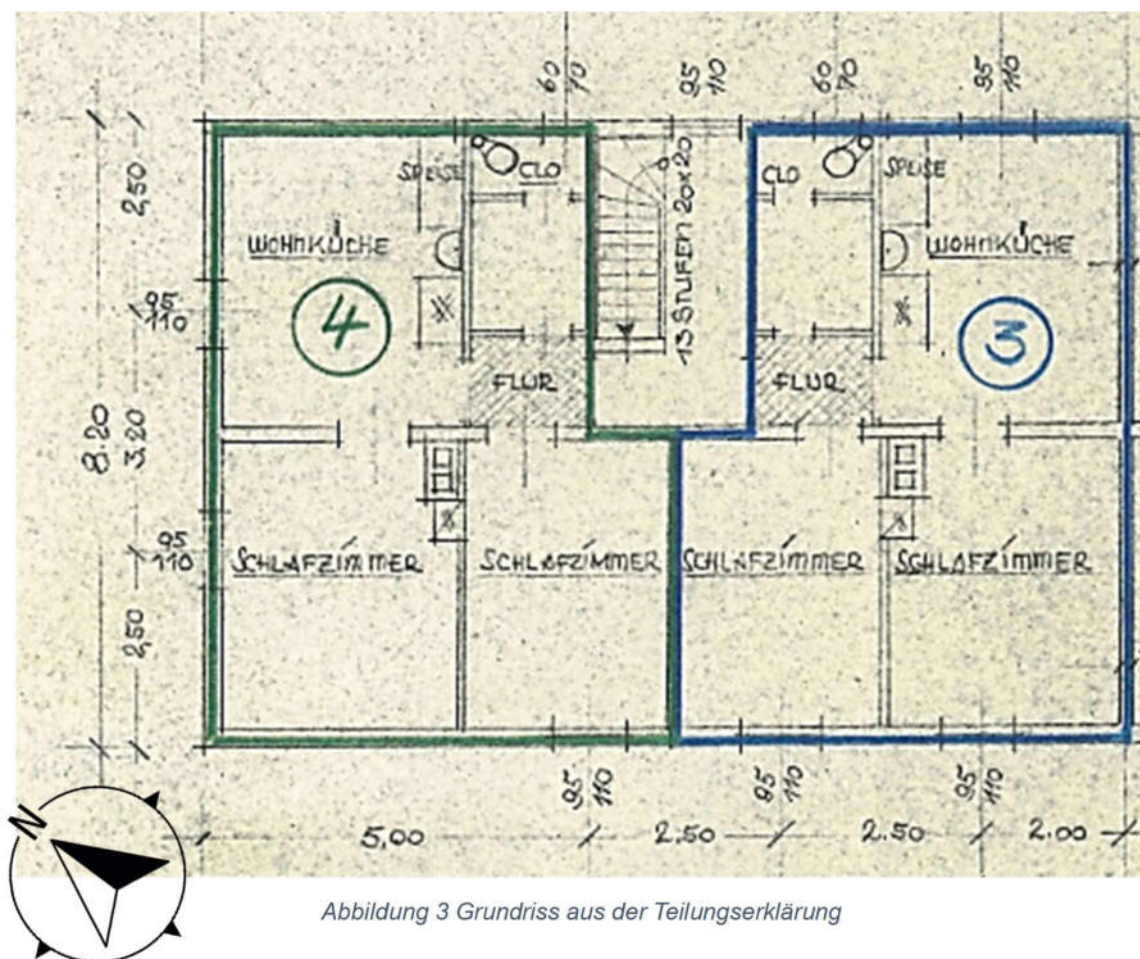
Grundriss aus der Teilungserklärung
